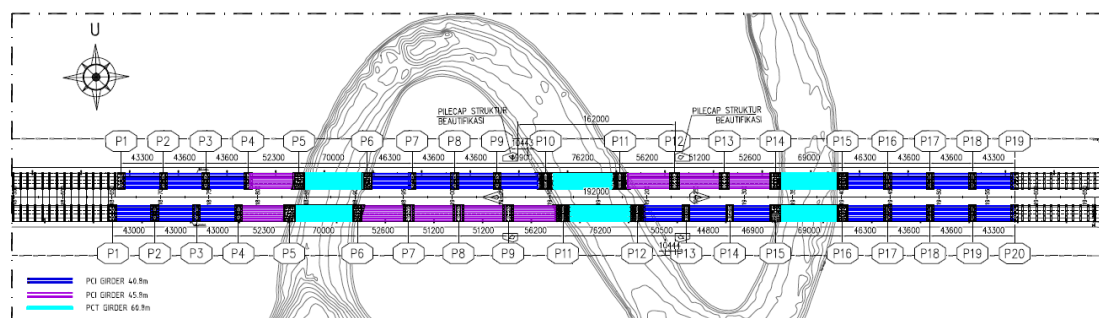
Lokasi Jembatan Sungai Wain pada Jalan Tol IKN Seksi 3A
